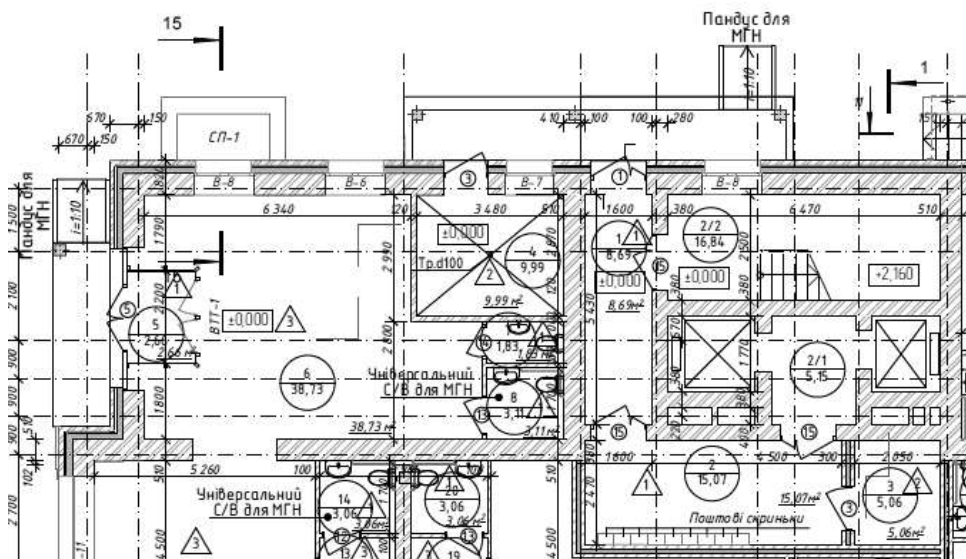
Фрагмент плану першого поверху житлового будинку.
